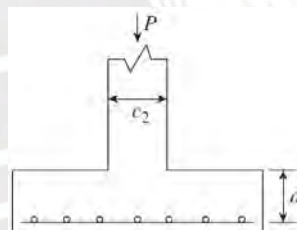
Sección típica de zapata armada con refuerzo de malla inferior²⁹
